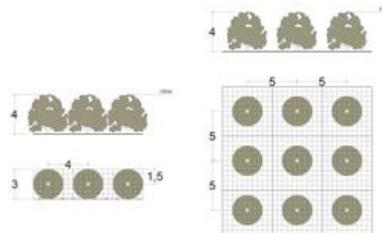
STRALCIO ELABORATO MAC2-PDT11
